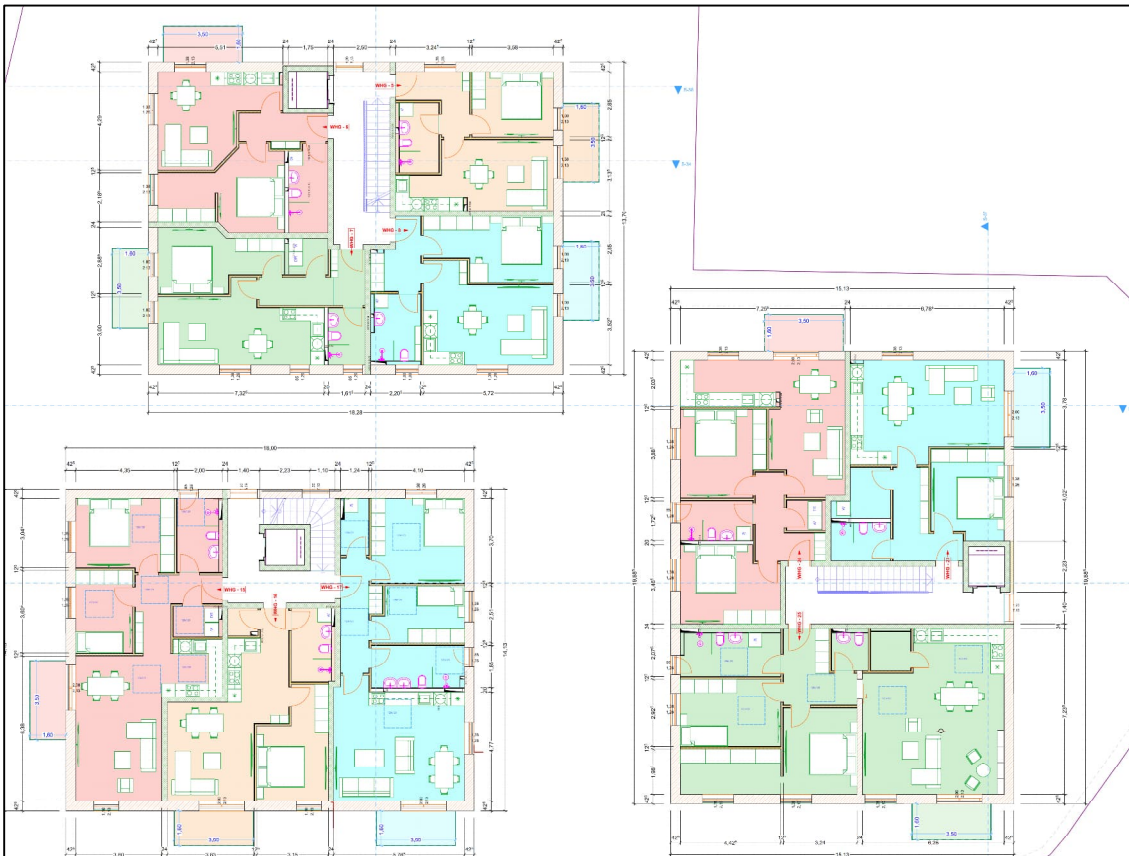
Grundriss des 1. Obergeschosses /19/
